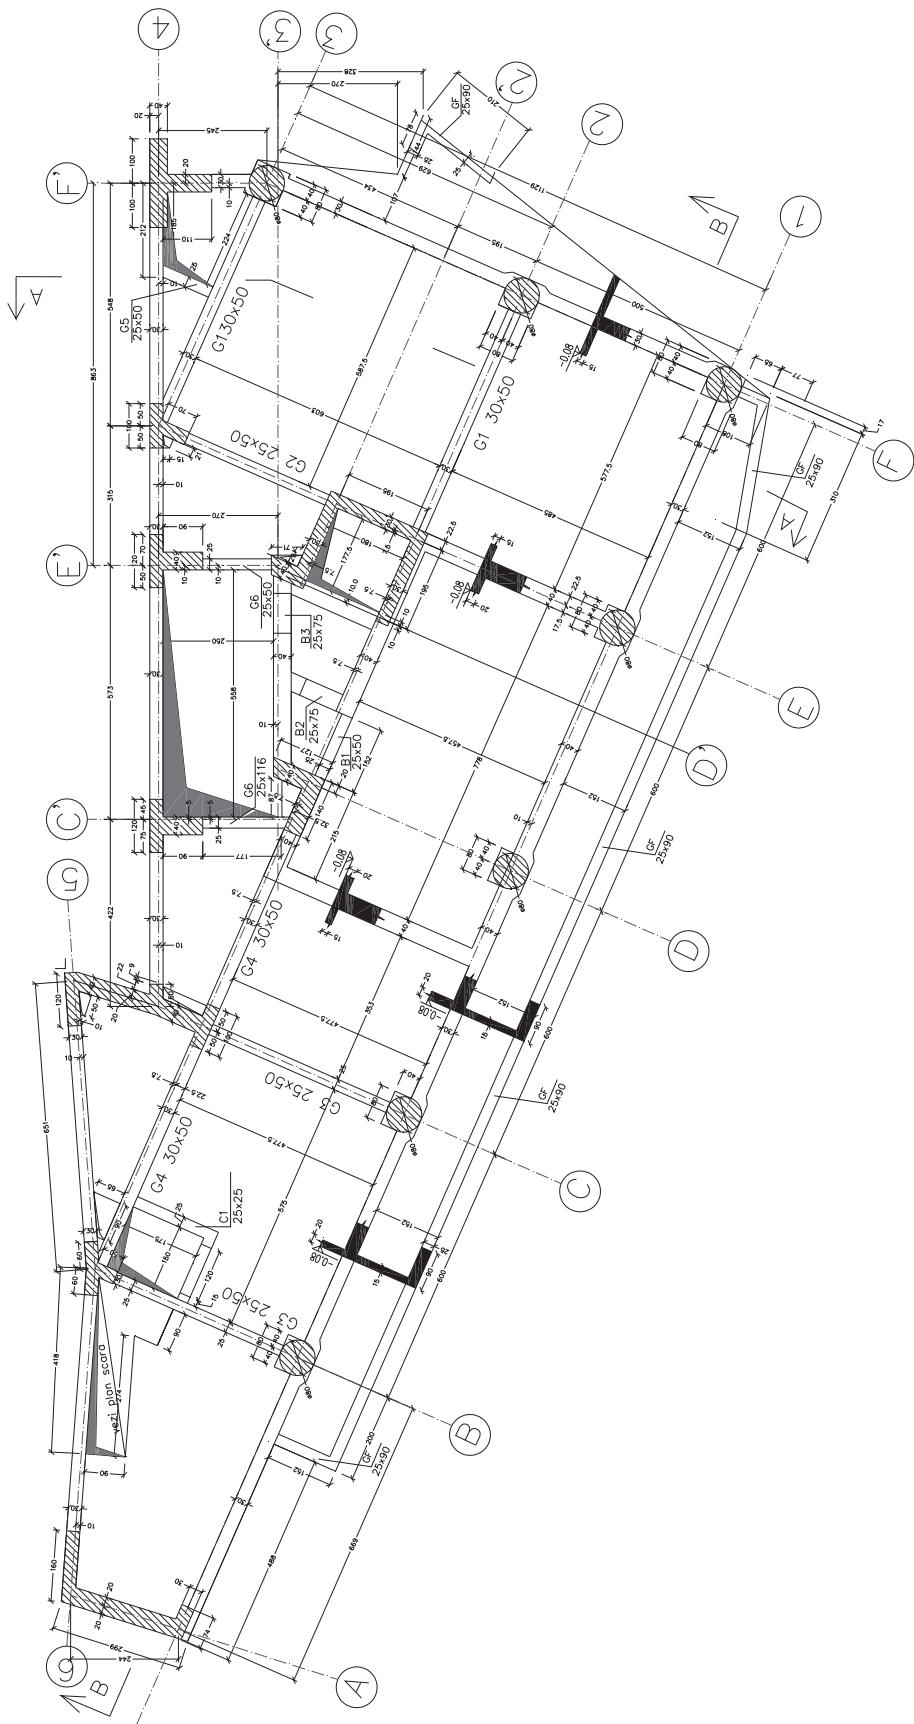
Plan cofraj planșeu la cota -0,08 m
